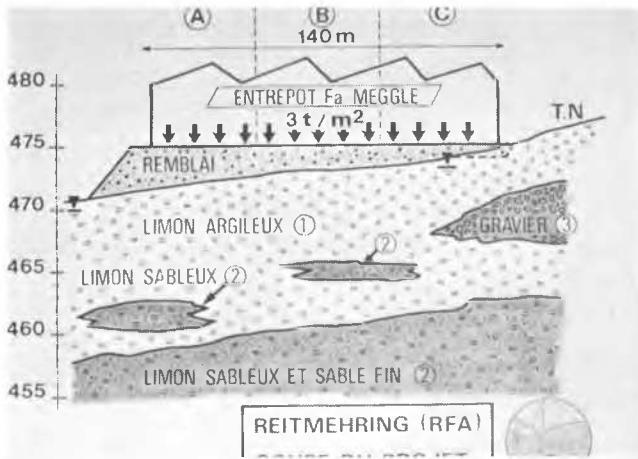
Coupe du projet de construction de l'entrepôt REITMEHRING / R.F.A.
